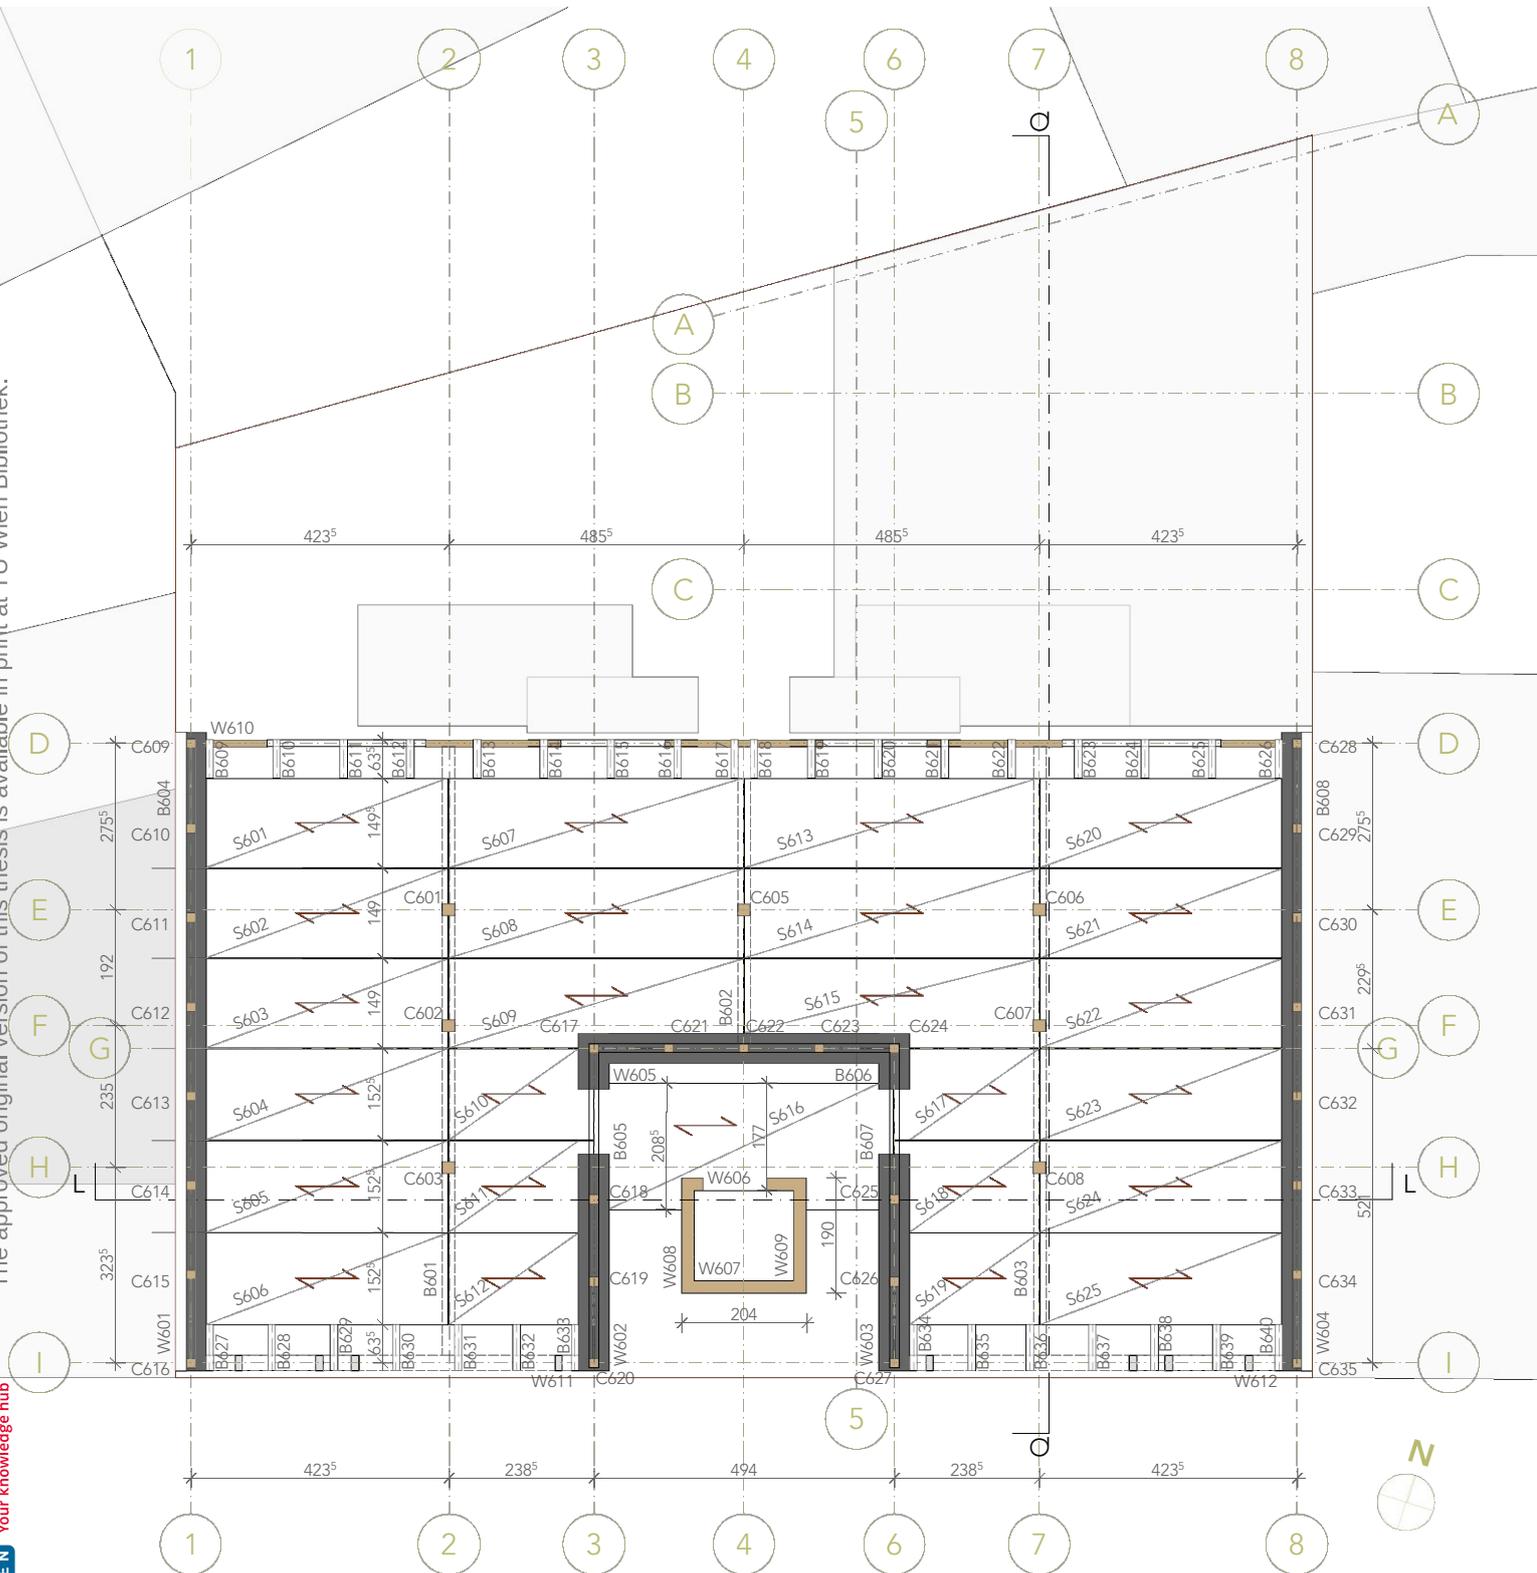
Tragwerksgrundriss, Dachgeschoss
